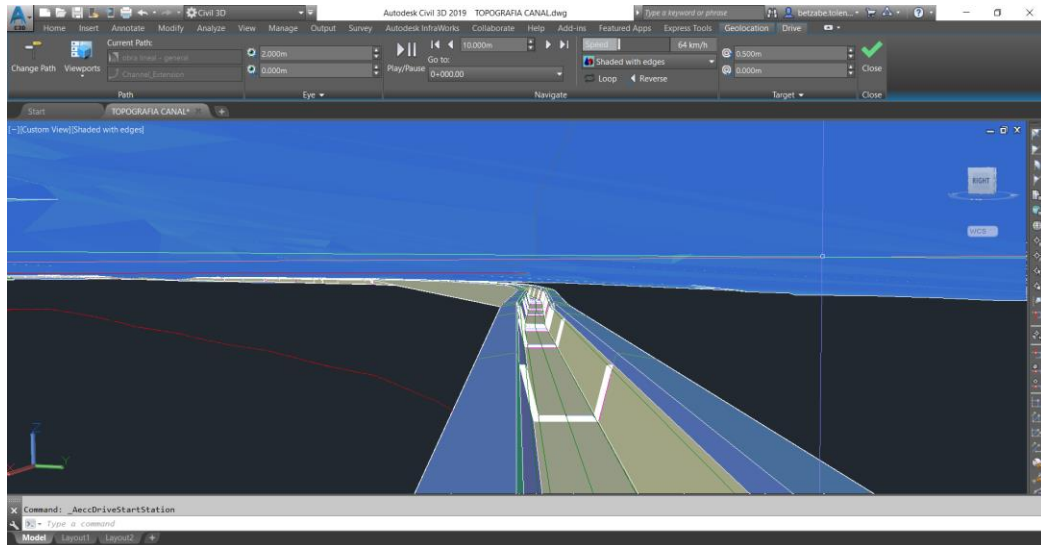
Modelado de canal abierto, sección trapezoidal – tramo inicial.
